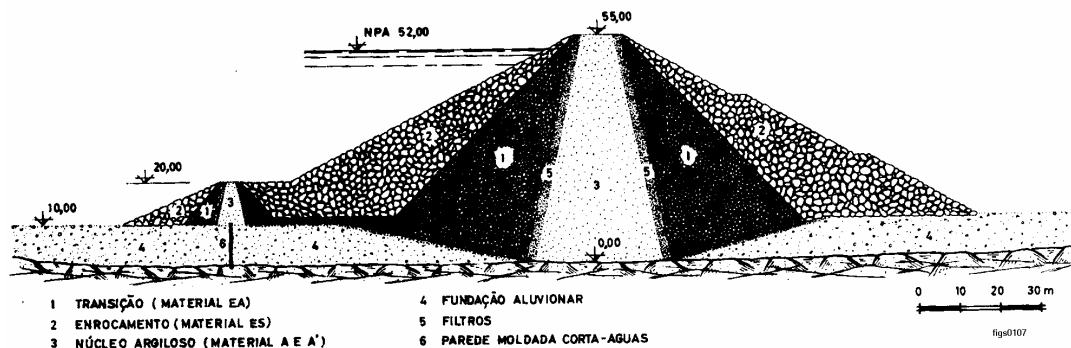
Perfil transversal-tipo da barragem de Beliche (Veiga Pinto, 1983)
